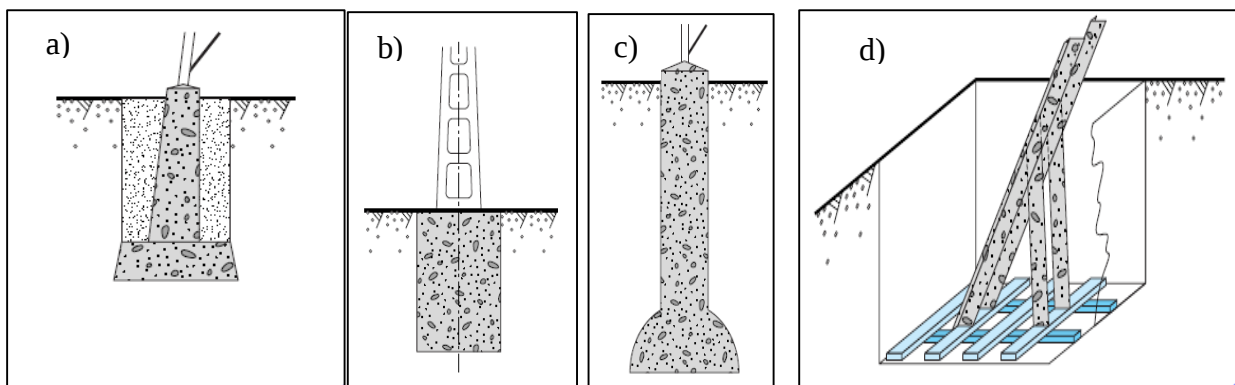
Fondation à dalle (a), fondation monobloc (b), fondation de type monobloc à bulle (c) et fondation monobloc à grille (d).
